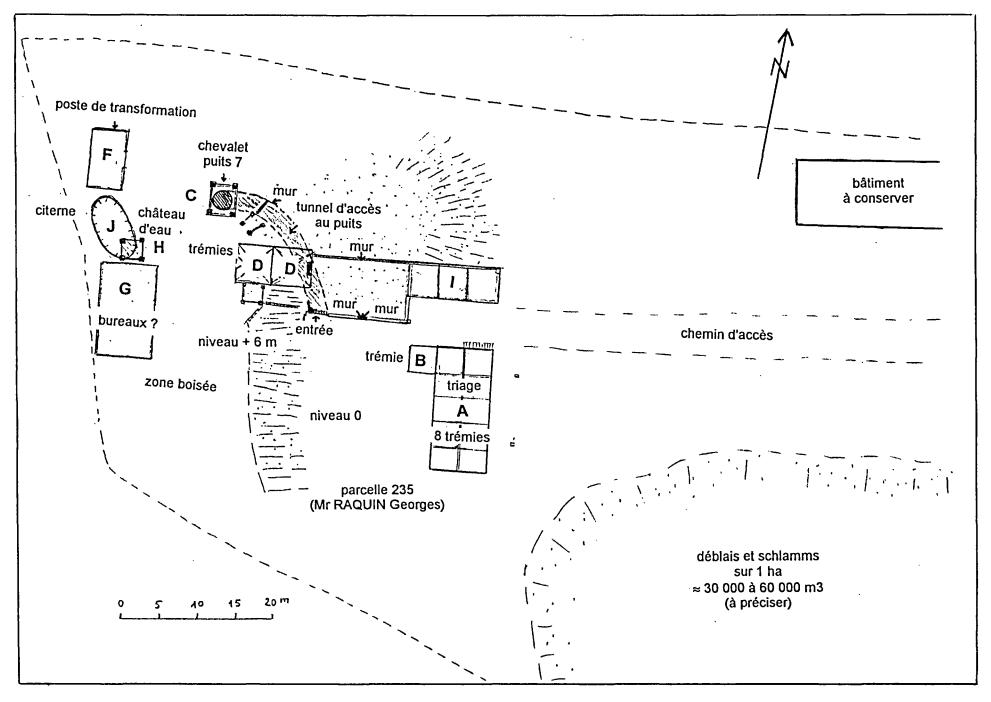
Plan des installations du puits 7 - échelle 1/500
